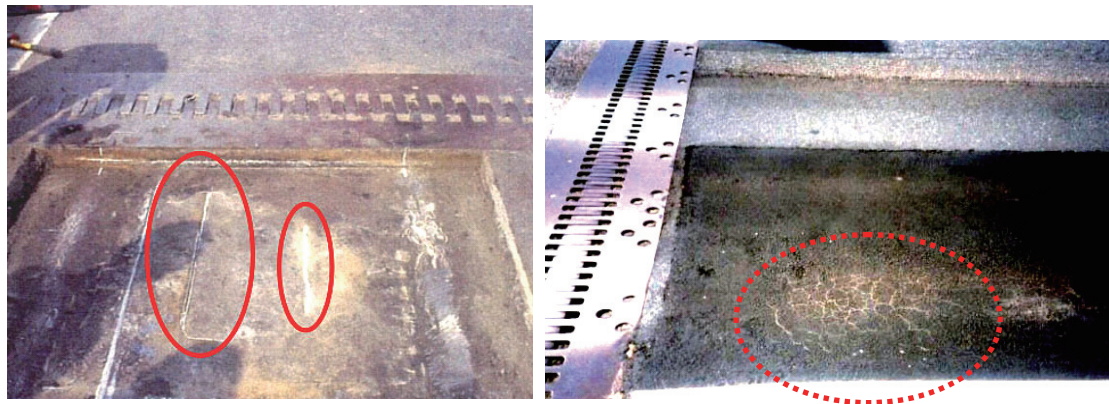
デッキプレート貫通き裂と舗装のひび割れ
